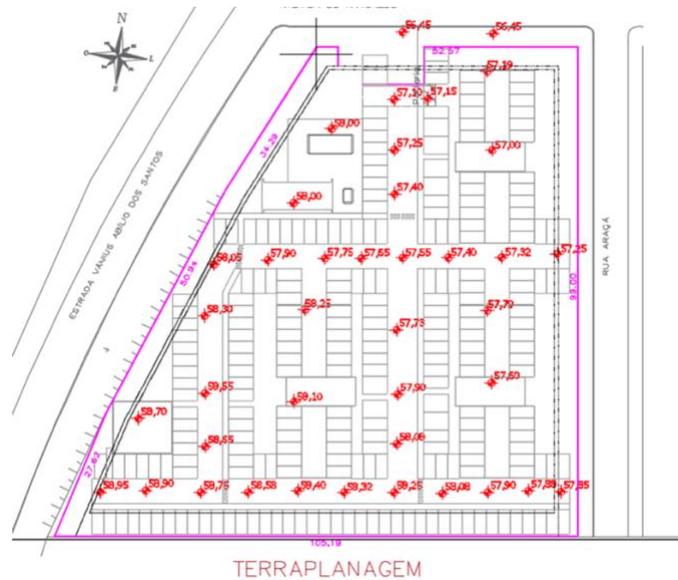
D – Terraplanagem com cotas da implantação do condomínio
